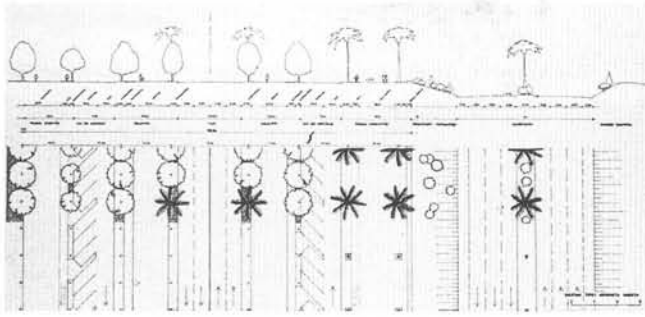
Sección y planta de bulvar y de tramo de nueva autovía desplazado en paralelo.
